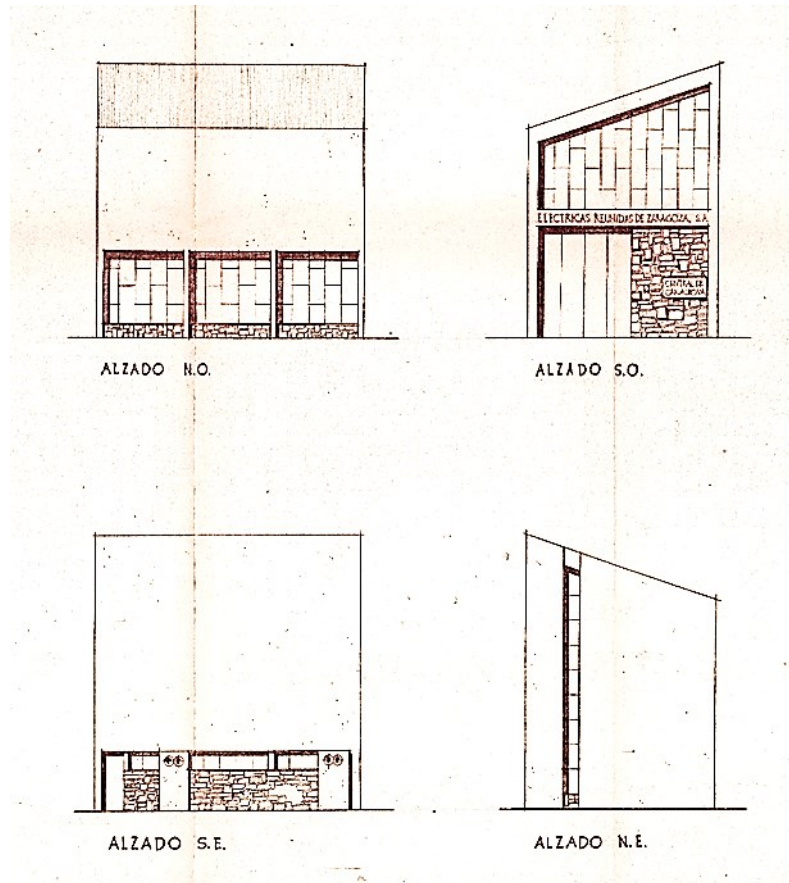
Alzados de las fachadas de la central de Canalroya según proyecto del ingeniero Conrado Sancho en 1964. Archivo CHE. Anexo XIX.
